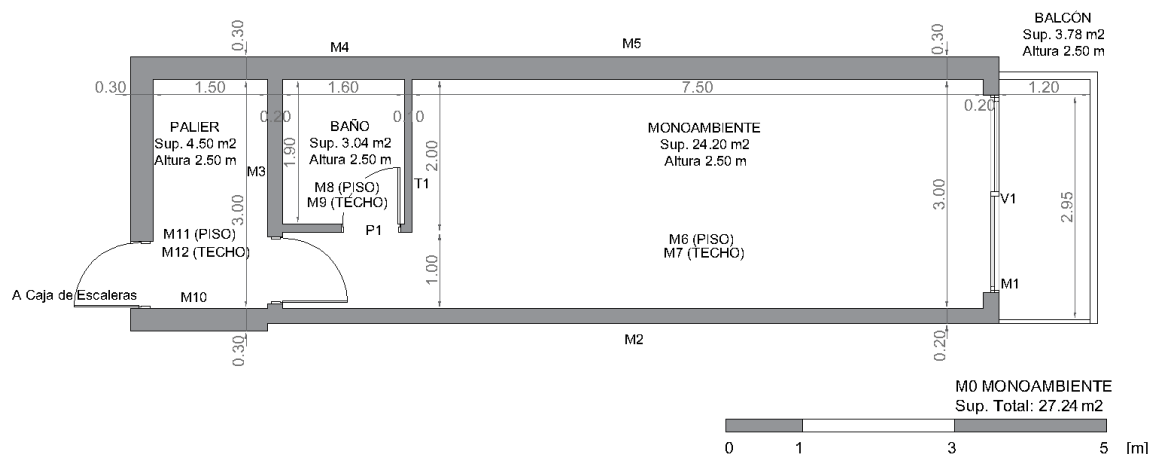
Esquema de planta del módulo M0. Elaboración propia del equipo.
